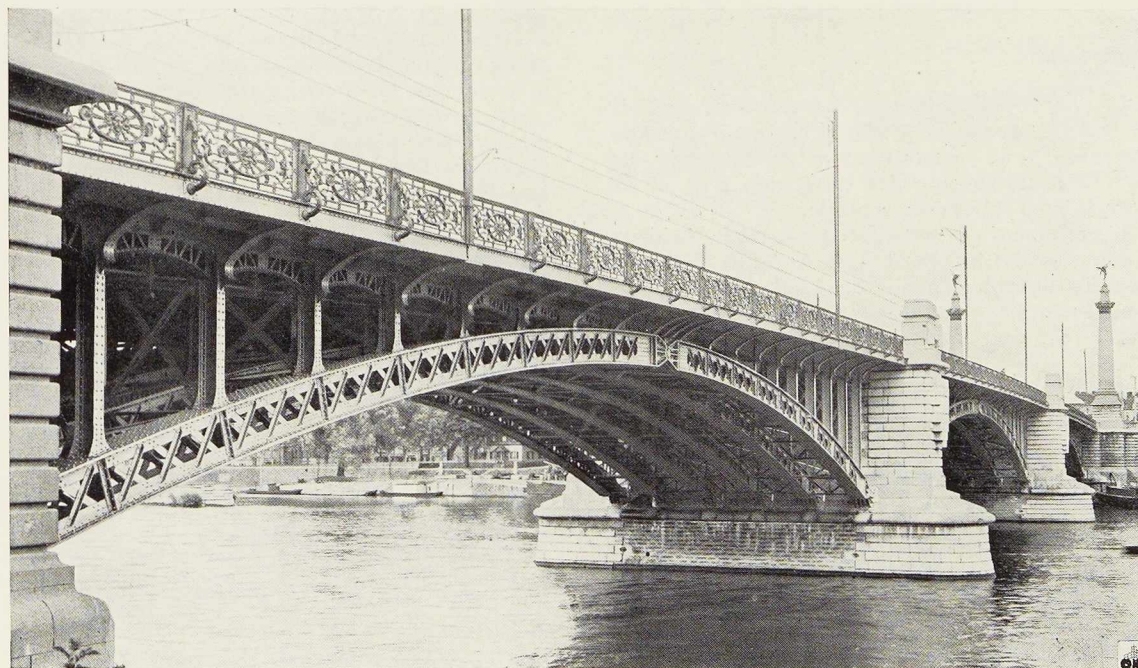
Vue d'ensemble du nouveau pont de Fragnée à Liège.
